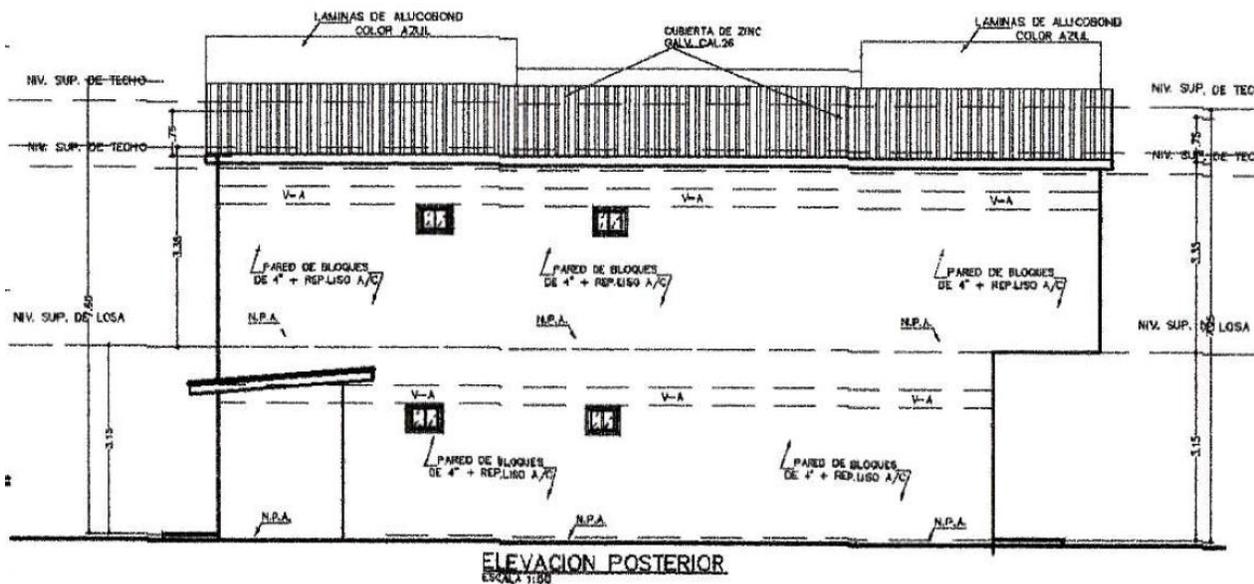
Elevación posterior “PLAZA TIERRAS ALTAS”
